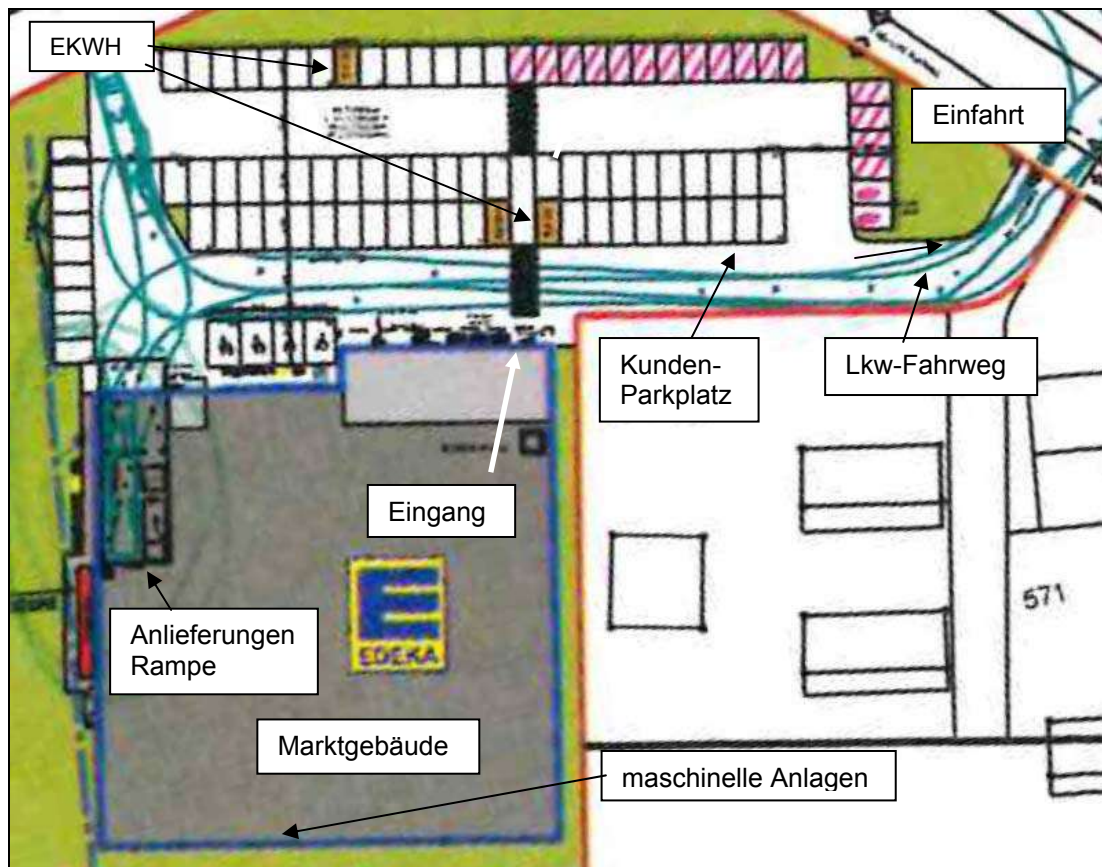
Lageplan des EDEKA-Marktes, aus [b] (in etwa genordet)
